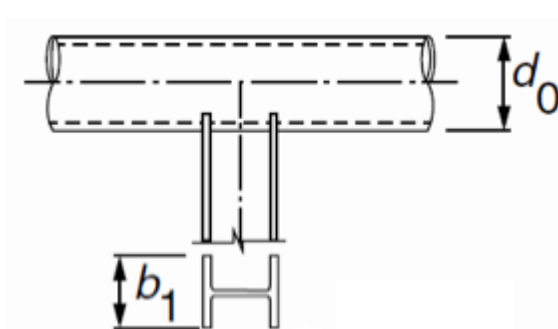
Exemplo de ligação entre viga de seção I e pilar tubular circular
